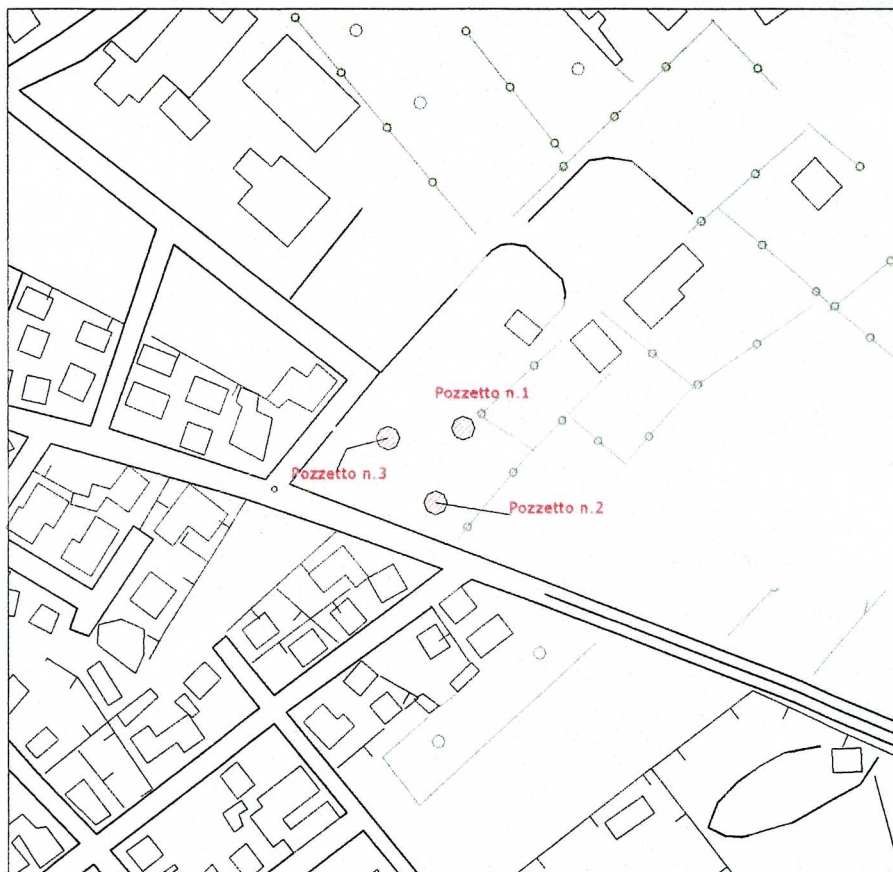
PLANIMETRIA DEI POZZETTI ESEGUITI
